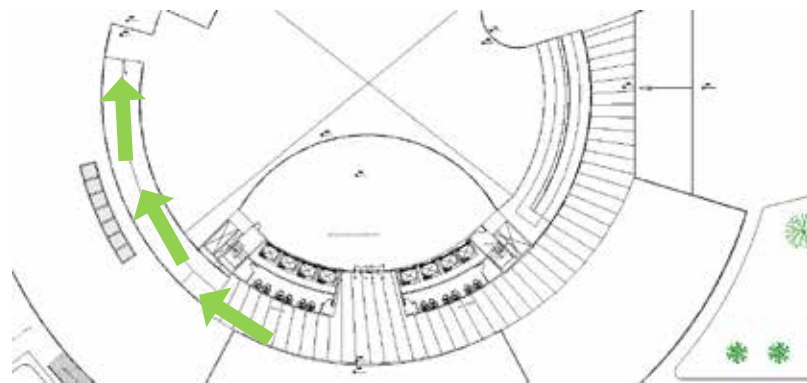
Plano de señalización de acceso vehicular.* Fuente: Plano Planta Baja (2019)
